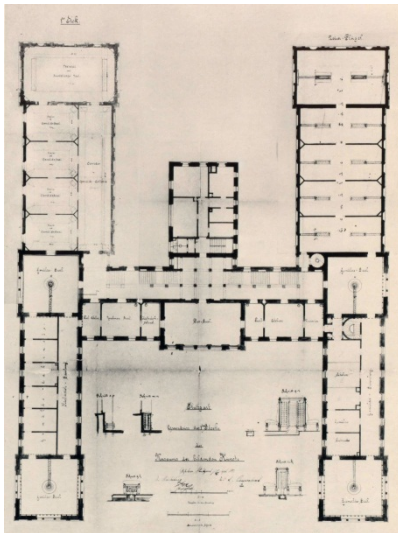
Erweiterungsplan für das *Museum der Bildenden Künste* von *Albert von Bok* 1880-84; Grundriss Obergeschoss;
